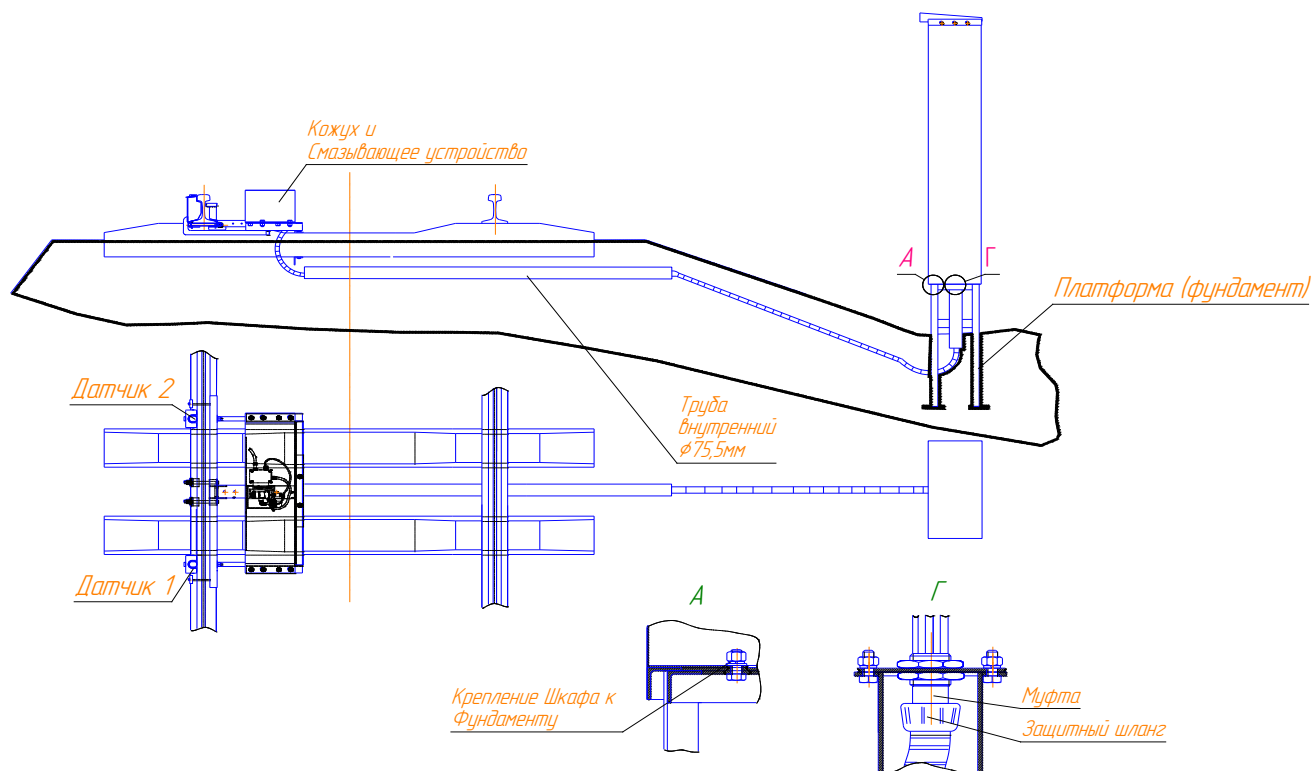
Стационарный путевой рельсосмазыватель СПР-02-М.1 с одним устройством смазки. Исполнение с двумя датчиками колеса.
